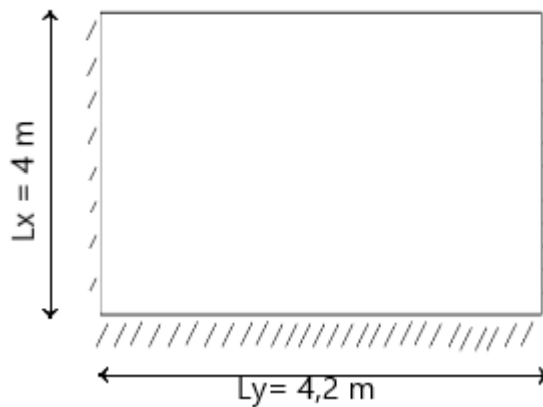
Dimensions d'une dalle pleine rectangulaire.
